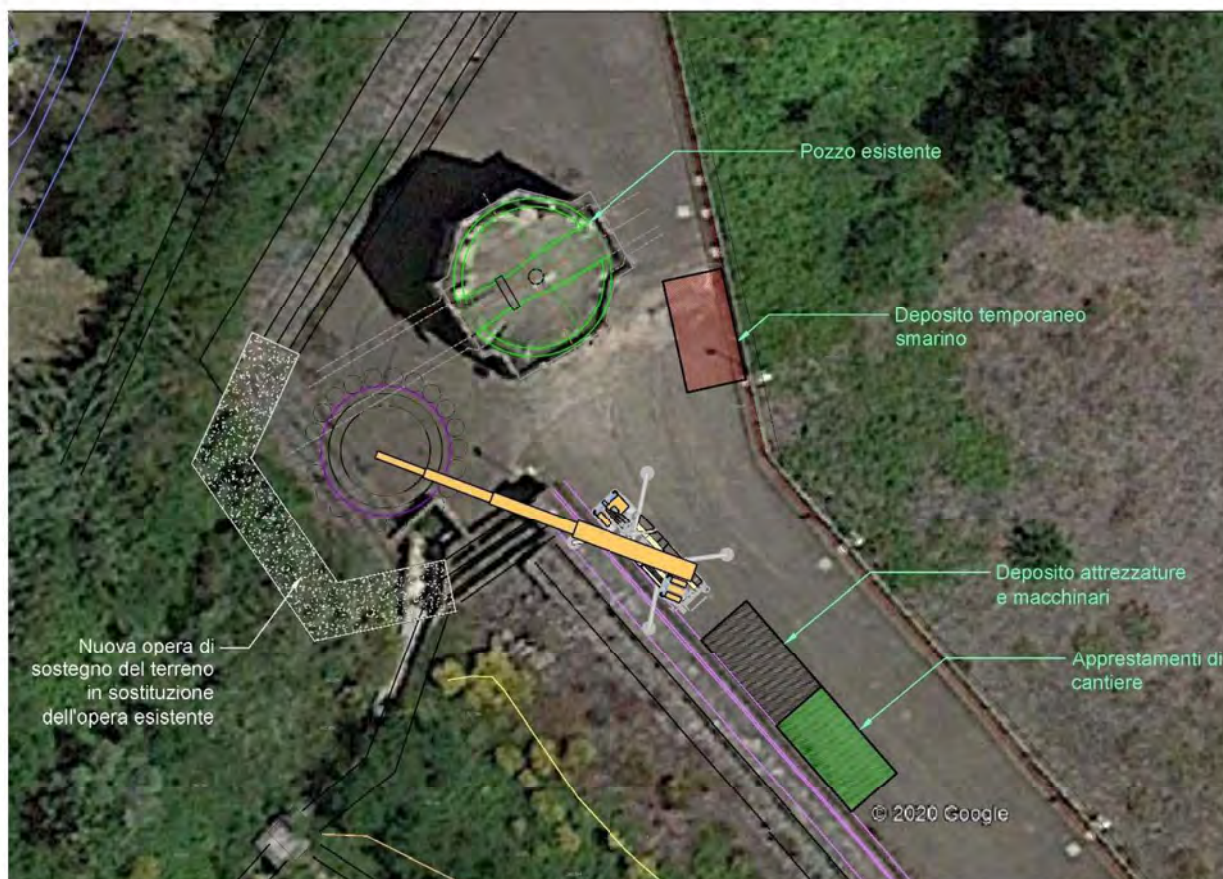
Layout cantiere pozzo di servizio e collegamento alle preesistenti opere di presa.
